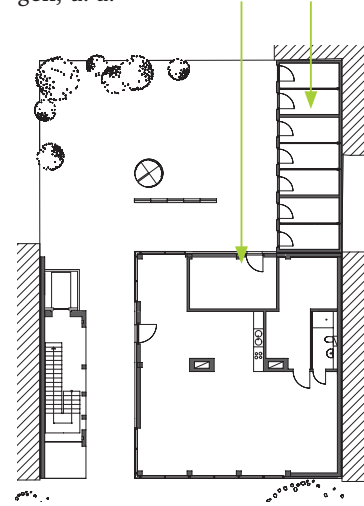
Grundriss EG o. M., Grafik: Büro Klingbeil + Kaden
